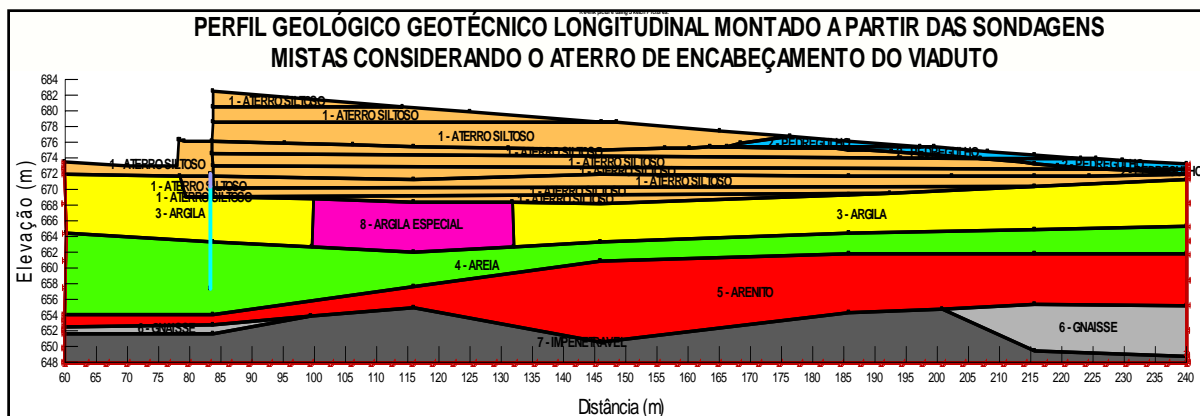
Perfil longitudinal do conjunto aterro e solo de fundação.
